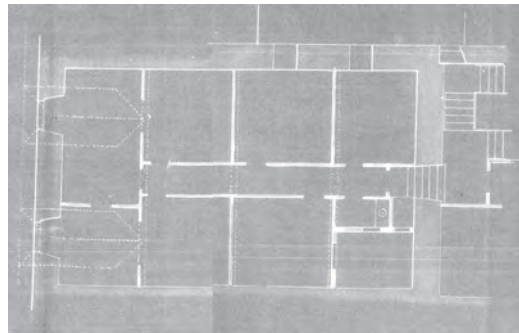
21. PLANTA BAJOCUBIERTA
